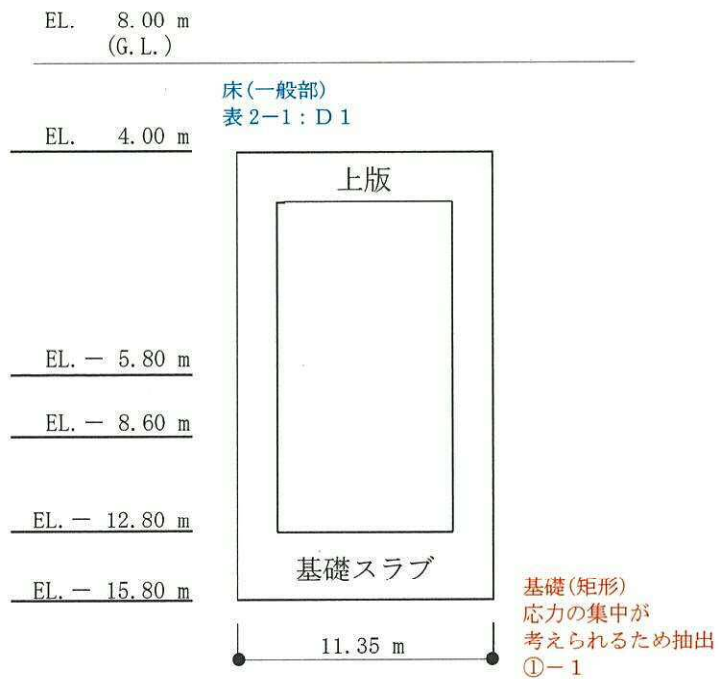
格納容器圧力逃がし装置格納槽の概略断面図 (EW 方向, B-B 断面)
